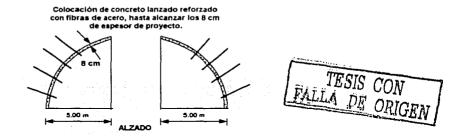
Colocación de la segunda capa de concreto lanzado de 4 cm.
